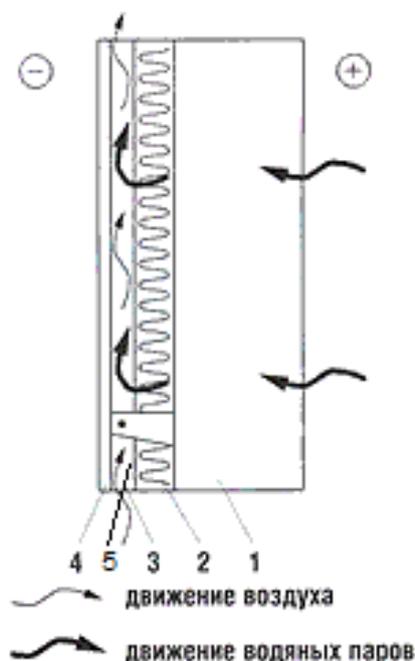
Конструкции наружных стен с вентилируемой воздушной прослойкой: 1 - утепляемая стена; 2 - утеплитель; 3 - вентилируемая прослойка; 4 - наружная облицовка; 5 – ветрозащитная пленка.
